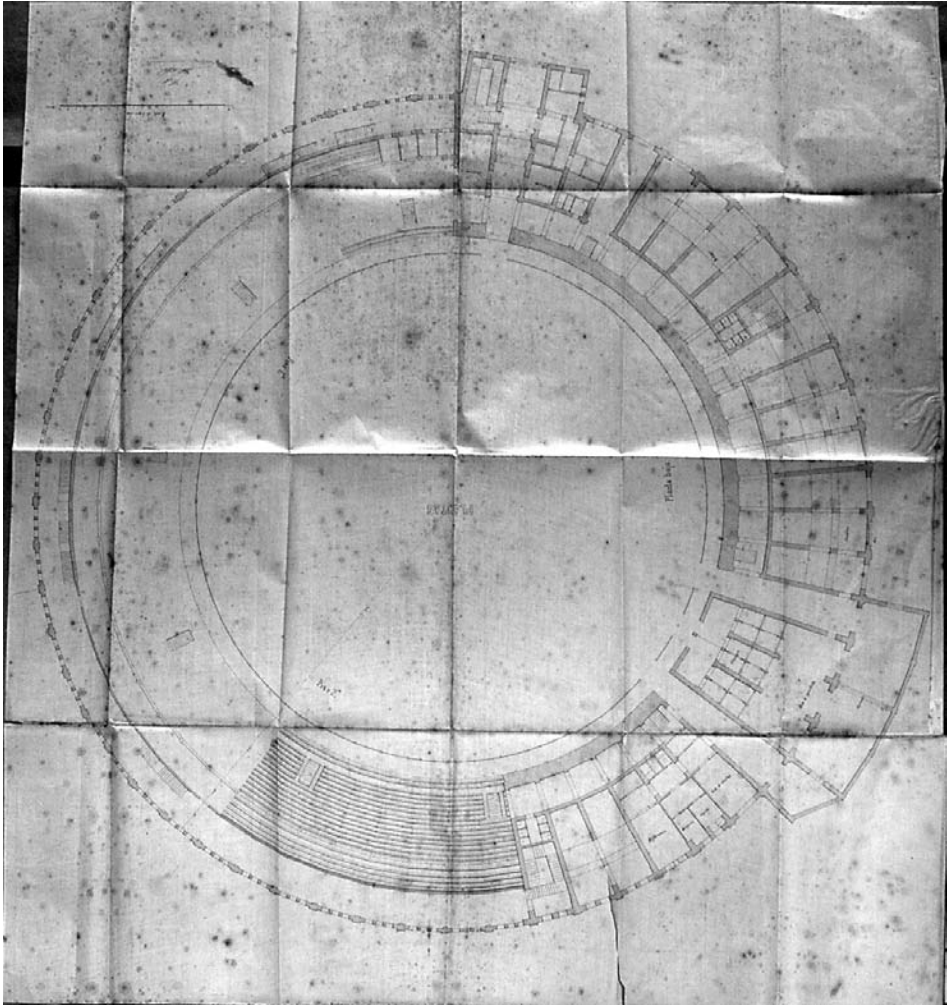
Plano de ruedo y tendidos de la plaza según proyecto.
